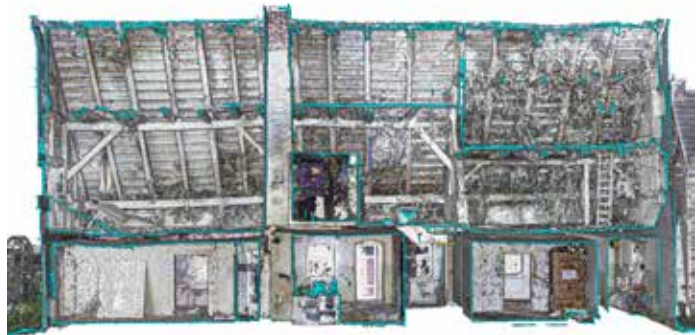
Ansicht der Punktwolke in 3dworks mit erstelltem Querschnitt durch Erd- und Dachgeschoss des Wohnhauses, Blick auf Nordseite des Giebels des ursprünglichen Fachwerkhouses. Die Zeichnung des Abbundes des Giebels mit Schwalbenschwanzverblattungen wurde aus der Punktwolke automatisch generiert und digital manuell nachbearbeitet. Bildrechte: Amir Besirovic.
